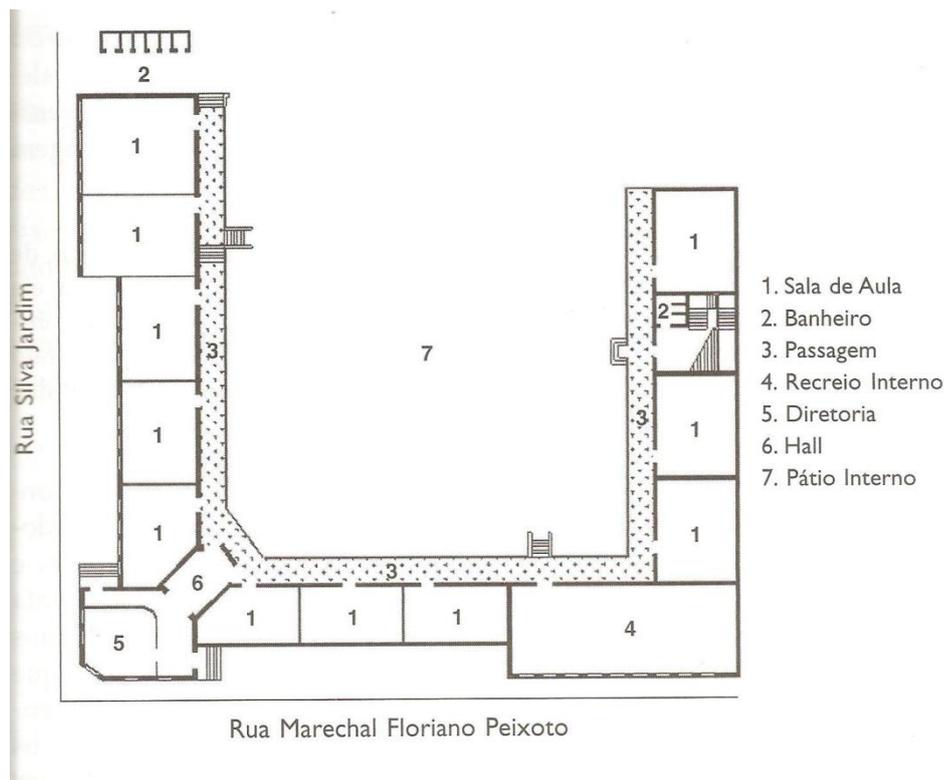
SUN PLANTA DO GRUPO ESCOLAR DR. XAVIER DA SILVA
